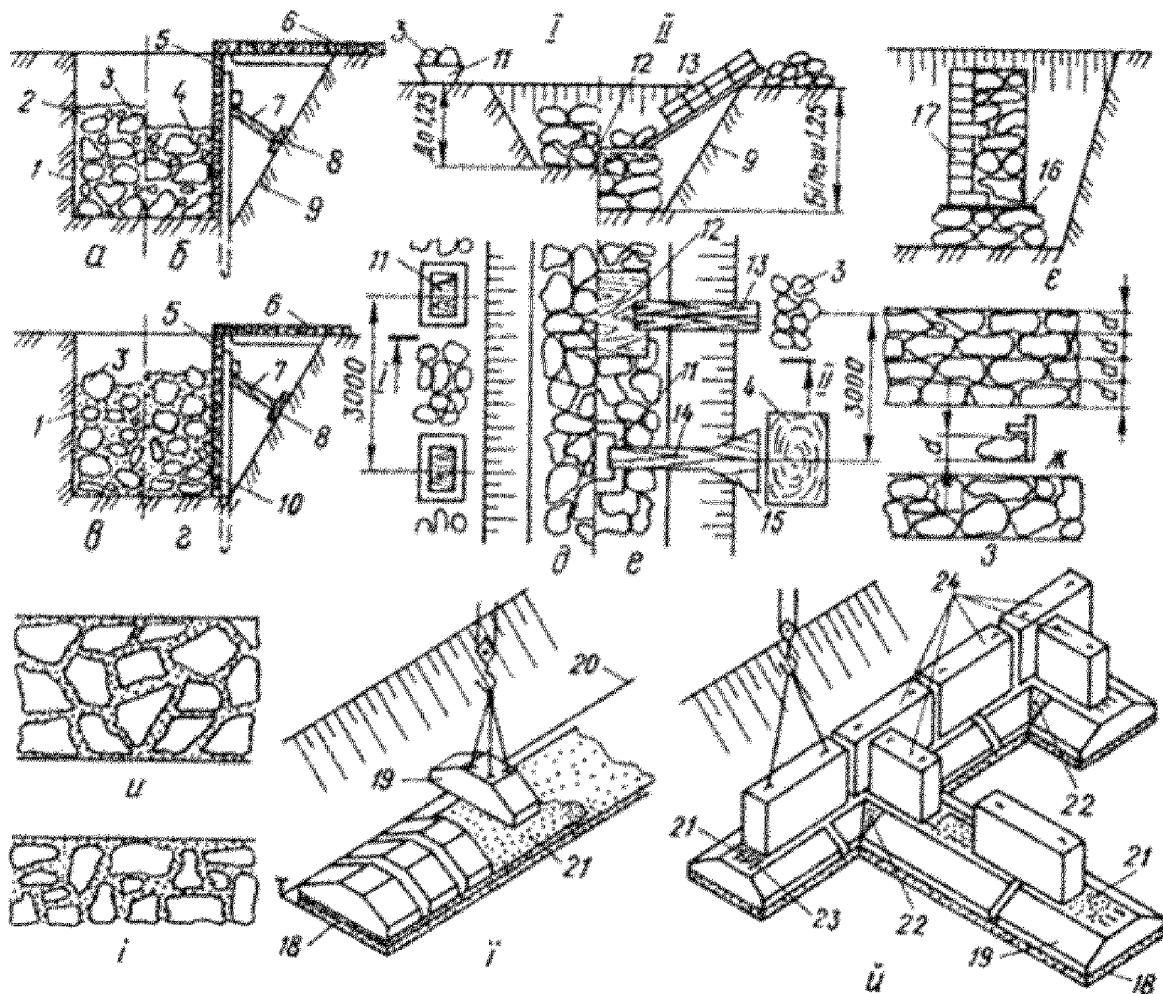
Зведення конструкцій підземної частини будівлі з бутового каменю і великих бетонних блоків:
